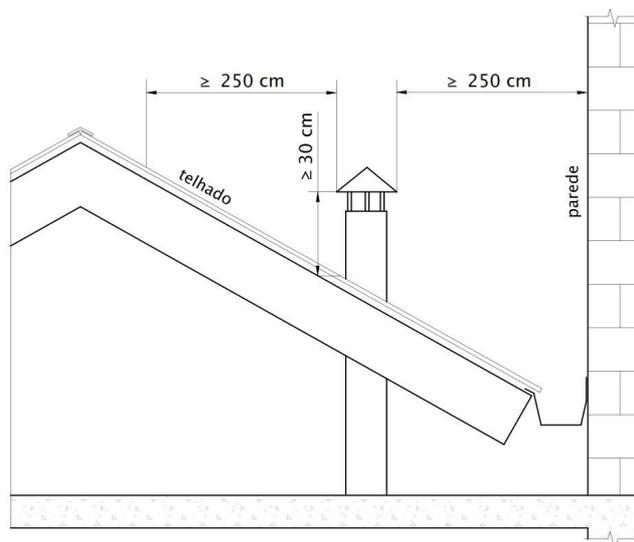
Instalação dos terminais verticais em coberturas com mais de 20° de inclinação.
